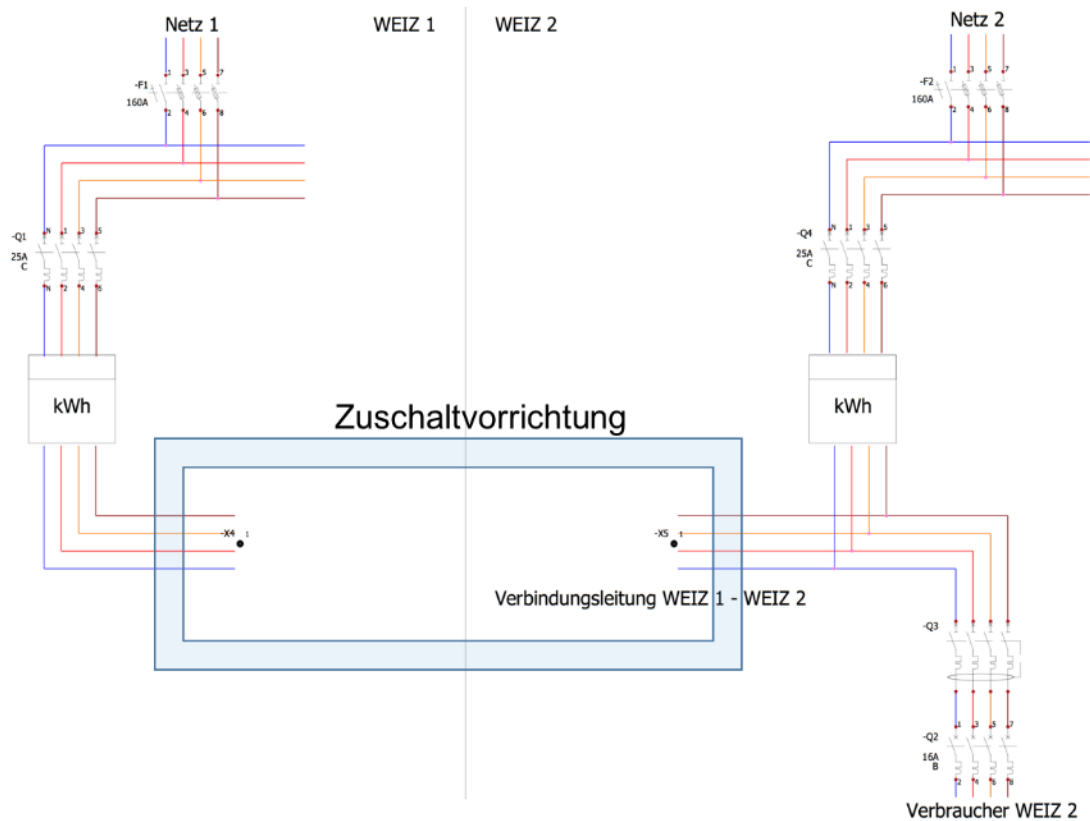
Einbettung der Zuschaltvorrichtung in die bestehende Installation (Pilotprojekt 1)
